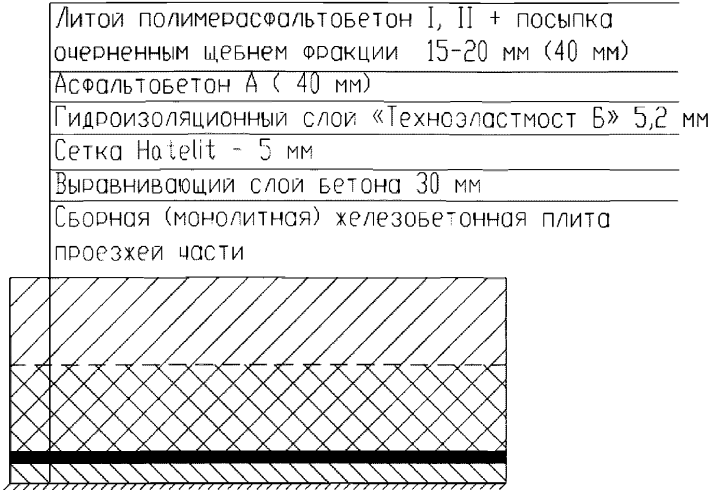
Дорожная одежда с применением литого полимерасфальтобетона и рулонной гидроизоляции на железобетонной плите проезжей части моста
